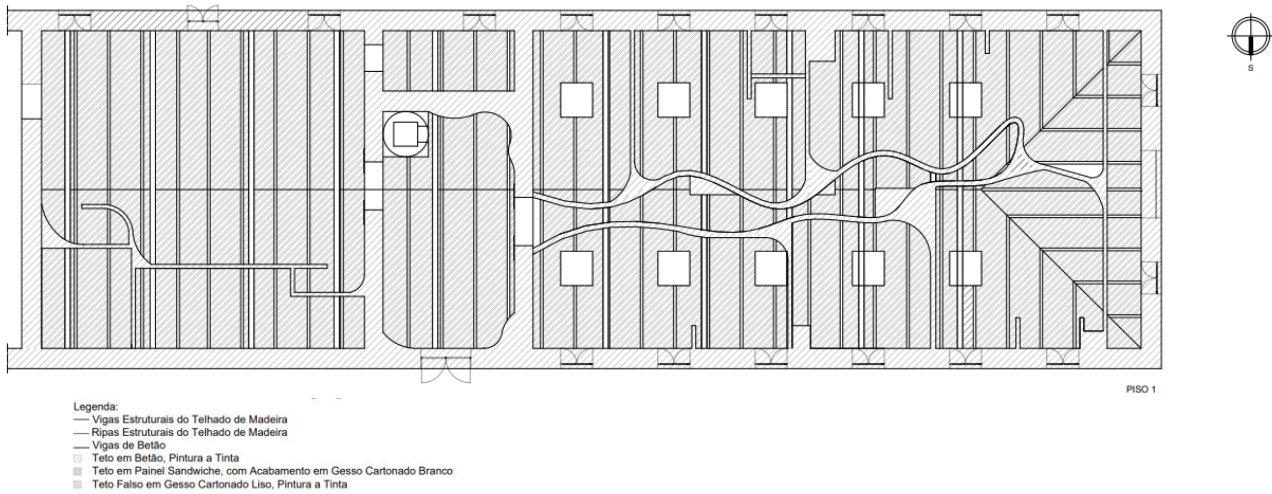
I - Planta de Tetos, Piso 1, Alojamento Olive
